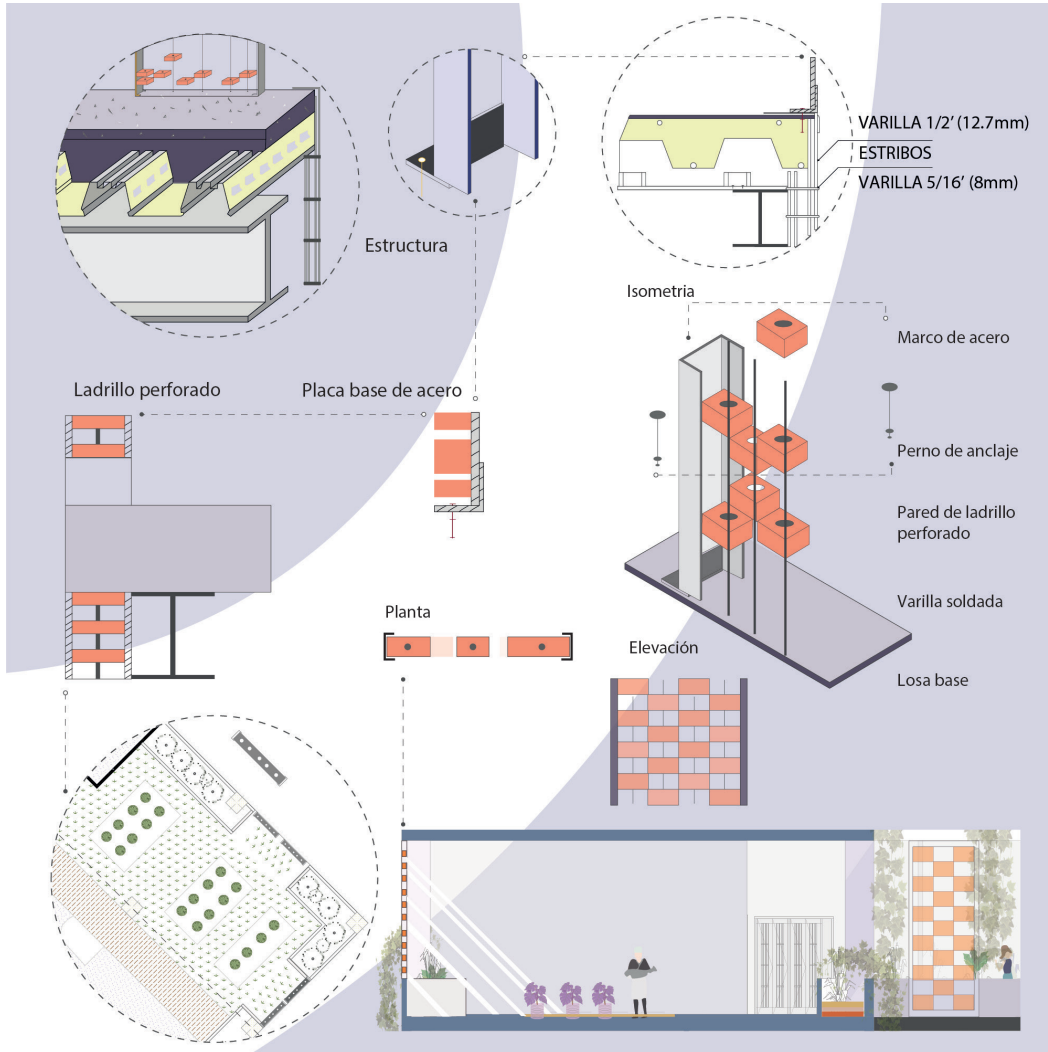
Detalle muro ladrillo en fachadas y huertos
